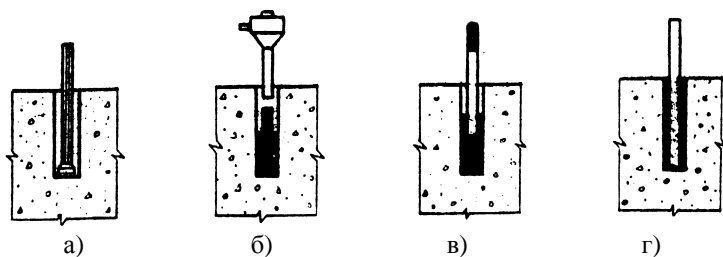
Установка арматурных стержней: а – бурение шпуров; б – заливка акрилового клея в шпуры; в – установка арматурного стержня в шпуры; г – установка арматурного стержня в проектное положение.
